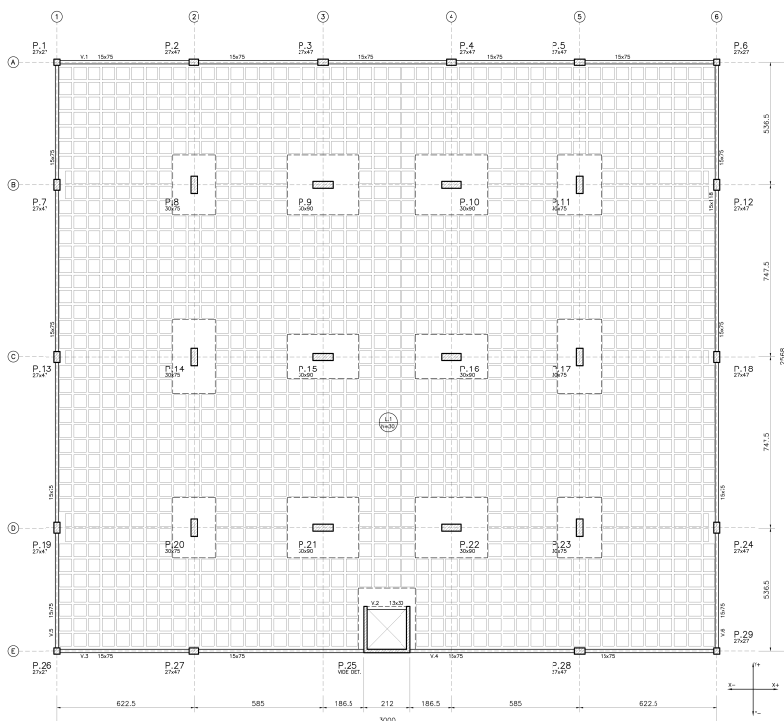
Forma do pavimento tipo da Estrutura 2A.
